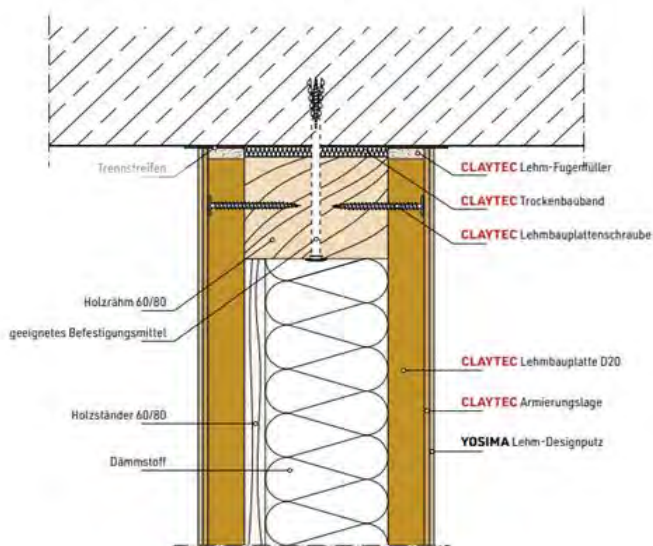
Anschluss an Massivdecke mit Holzunterkonstruktion. Dämmstreifen zur Entkopplung zwischen Beton und Holz, Trennstreifen zwischen Beplankung und Massivdecke
